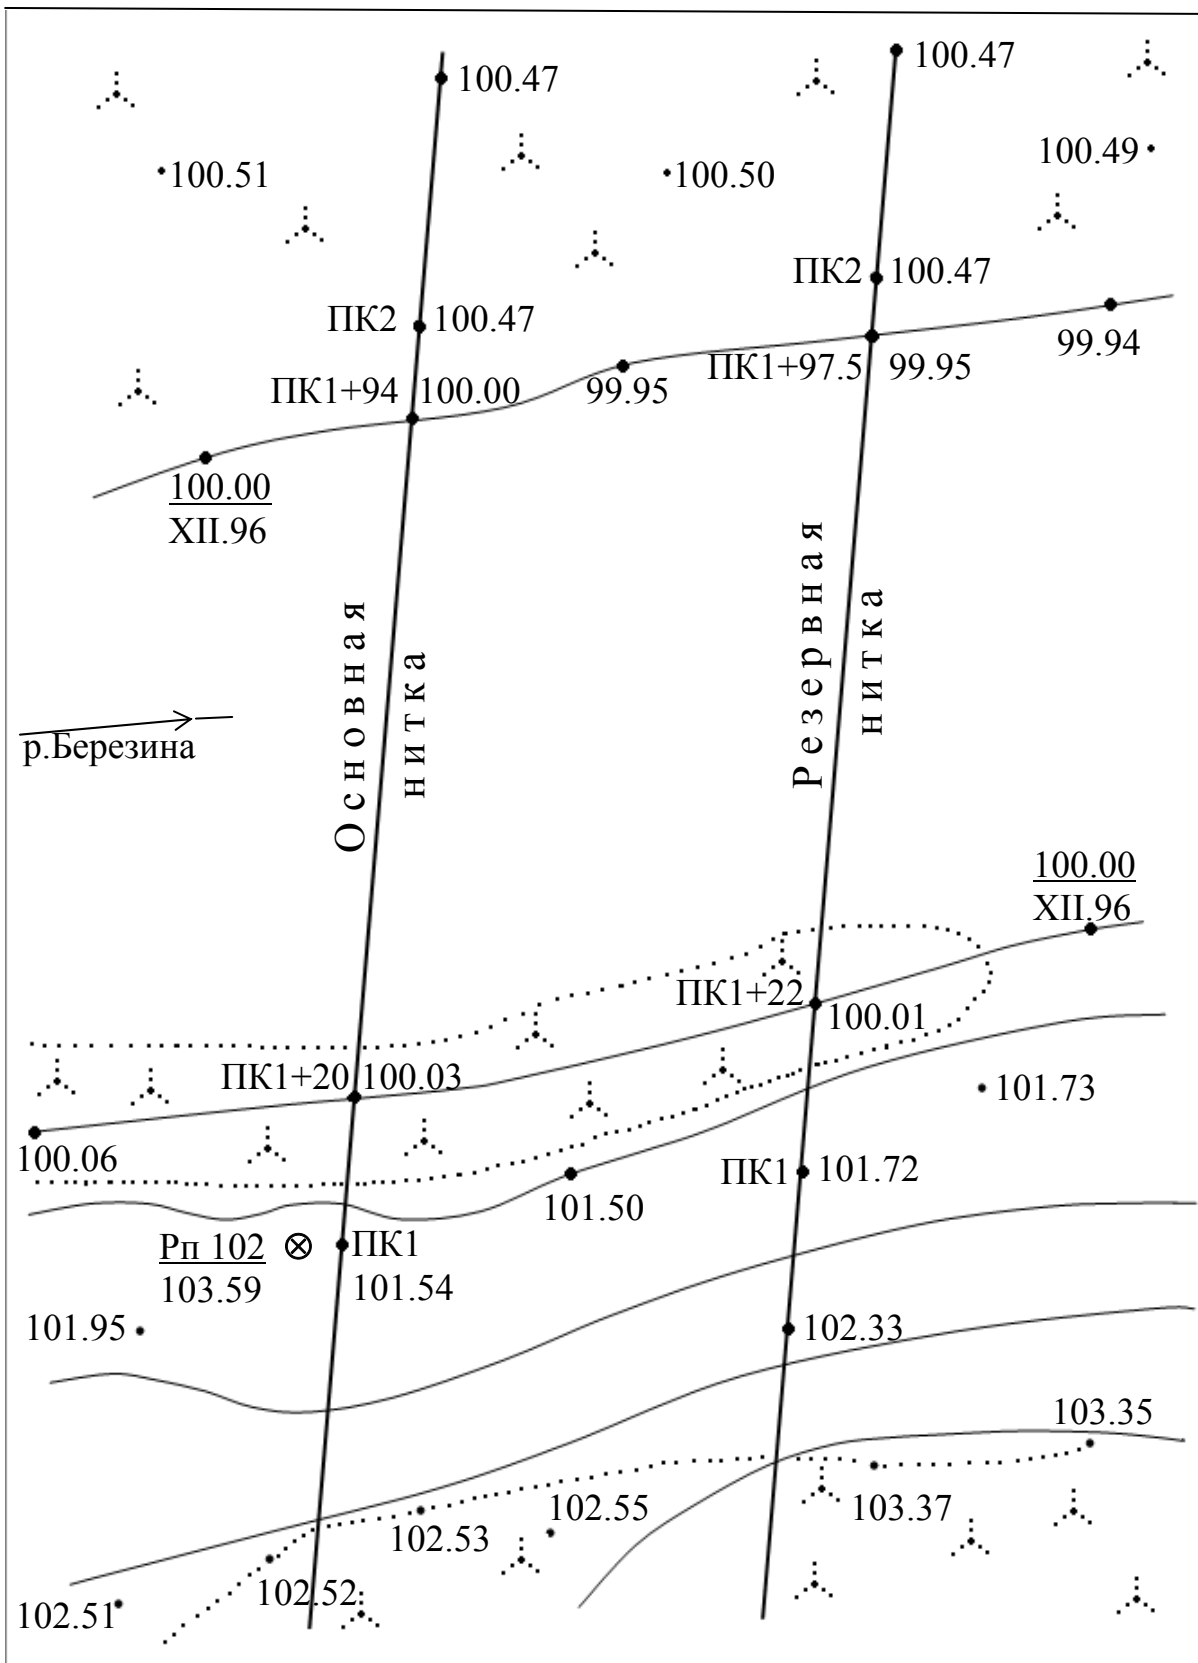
План масштаба 1:1000 подводного перехода газопровода Минск-Гомель через р. Березина
